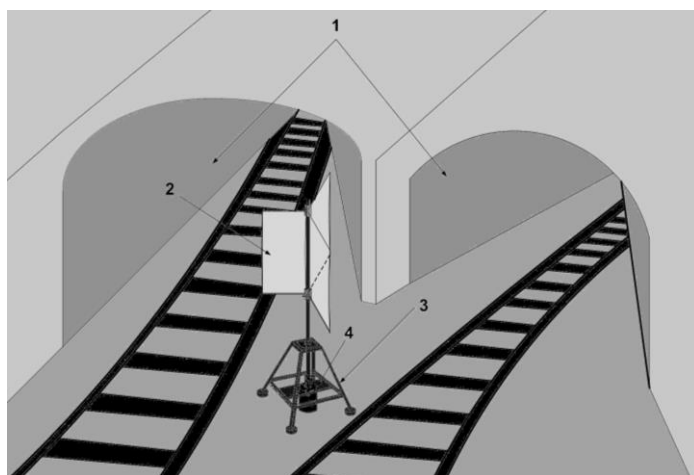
Схема розташування ВЕУ у шахті: 1 – перший та другий квершлаг, 2 – лопаті вітроколеса, 3 – металева опора вітроколеса, 4 – генератор.
